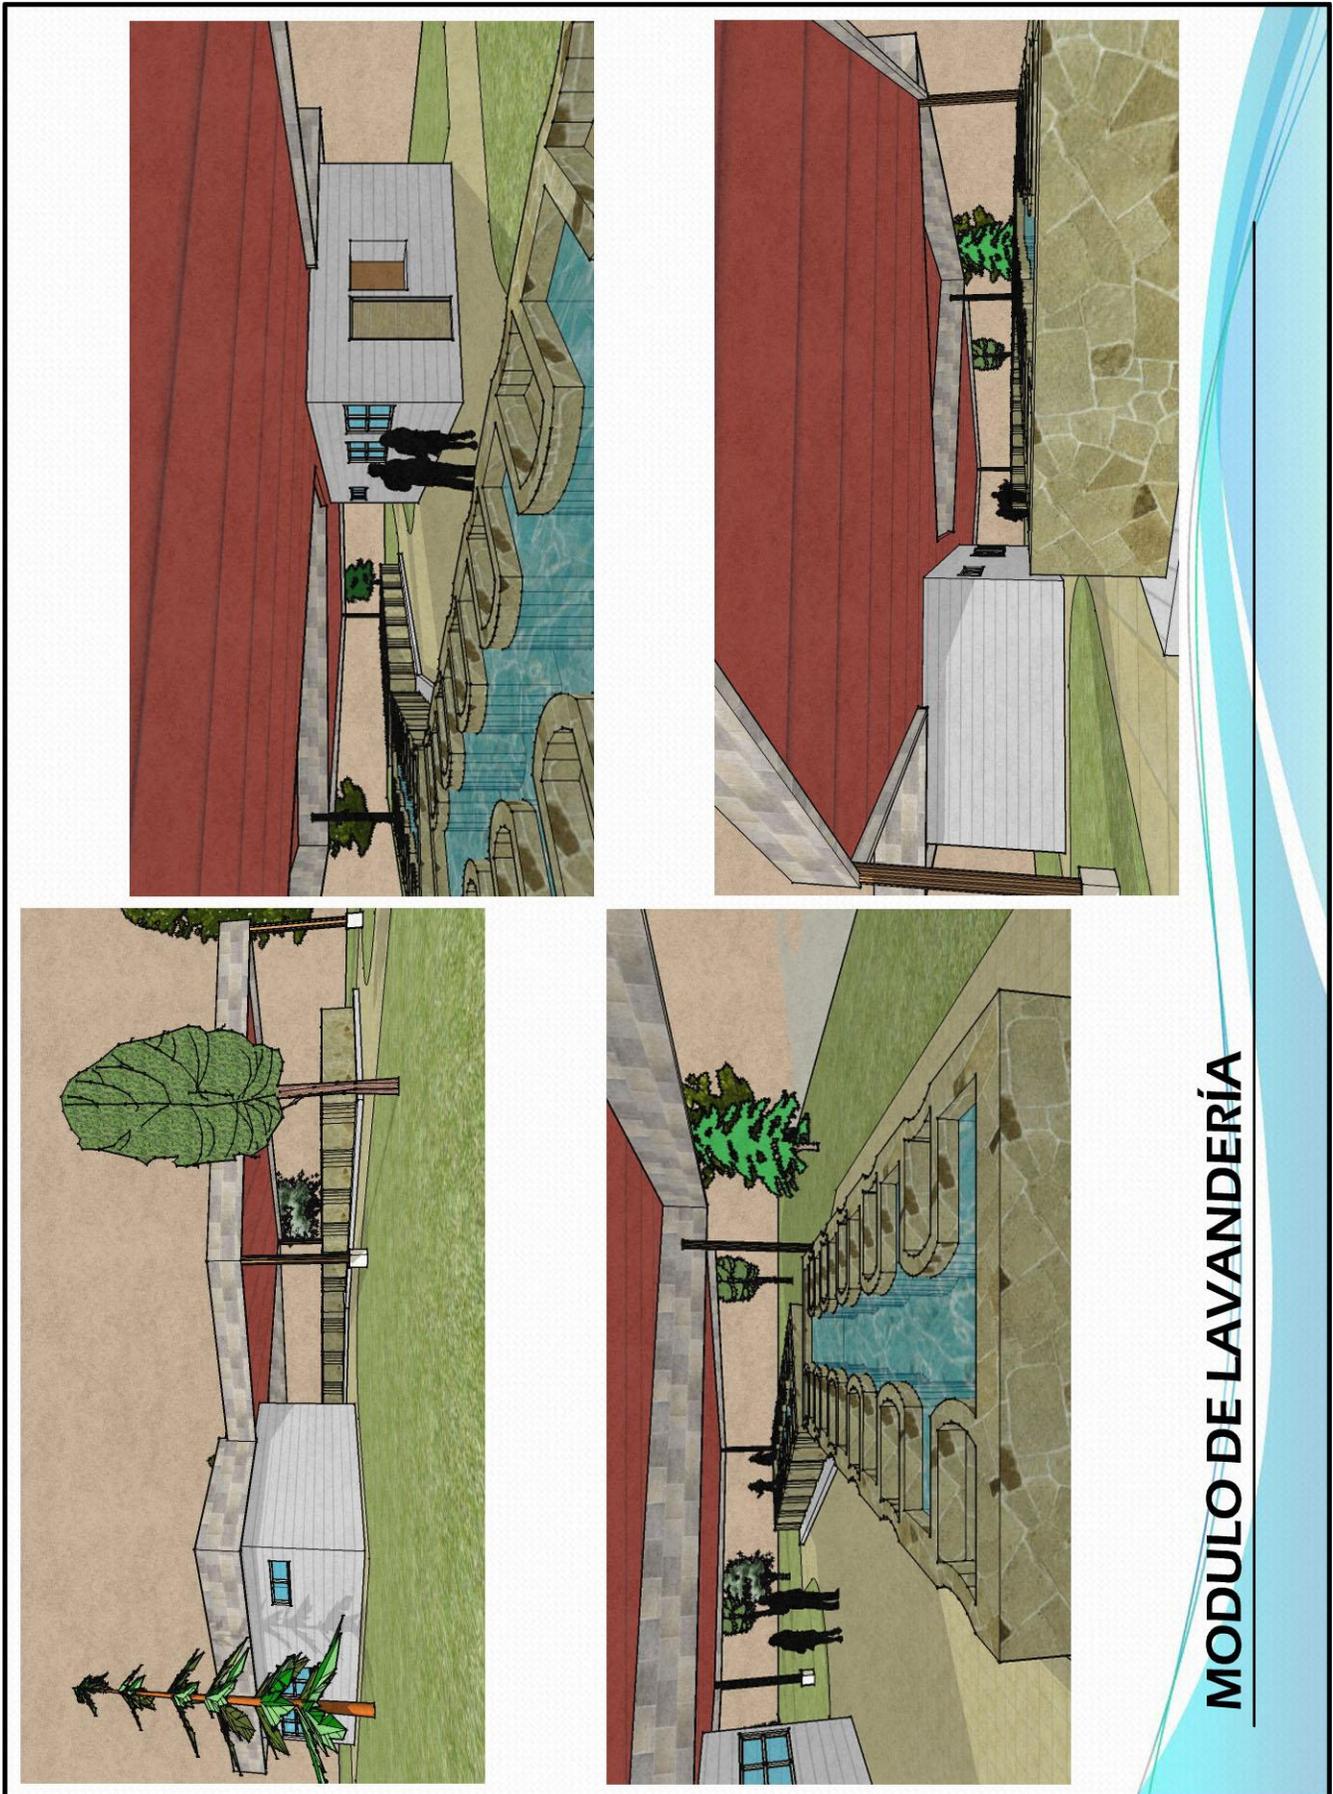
Anteproyecto para las Lavanderías, Elevaciones y Secciones.
